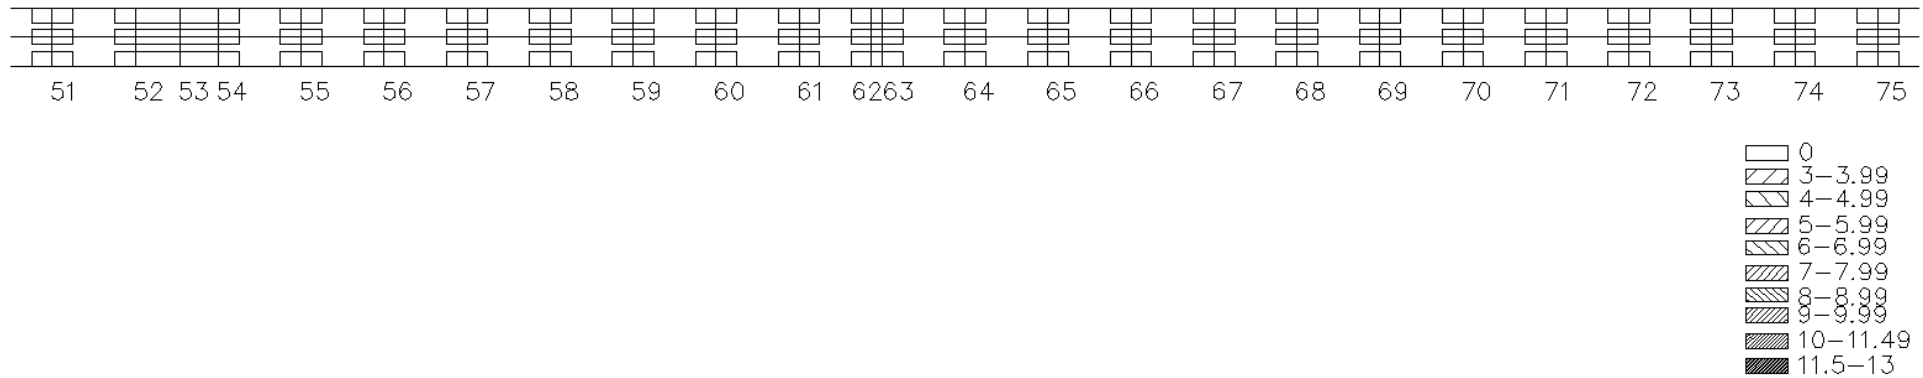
Ausgleichungsdicken bei kubischer Splinefunktion und Verfahrensplan Typ C, Grundriss, Stationen 51-75
